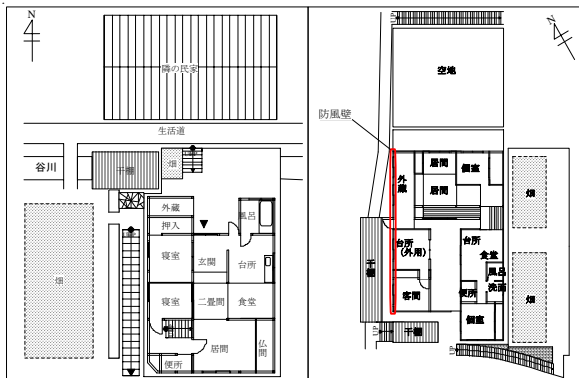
母島集落民家平面図 図6 弘瀬集落民家平面図
